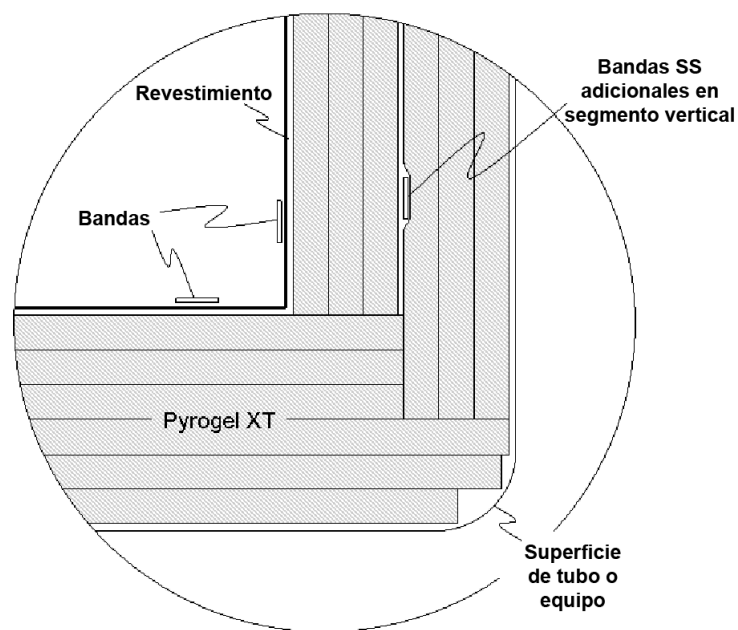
Junta correctamente “escalonada” en un cambio de la dirección del aislamiento (ejemplo, en una conexión en T).
